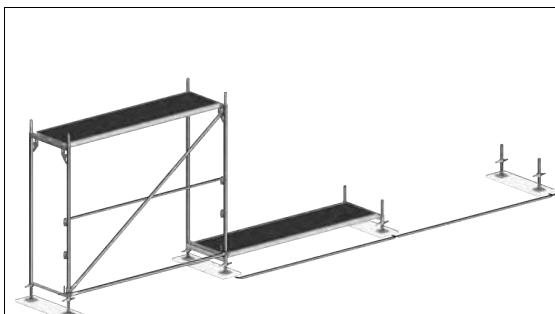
Fertiggestelltes erstes Gerüstfeld, Ausführung bei geplantem Weiterbau mit MSG
